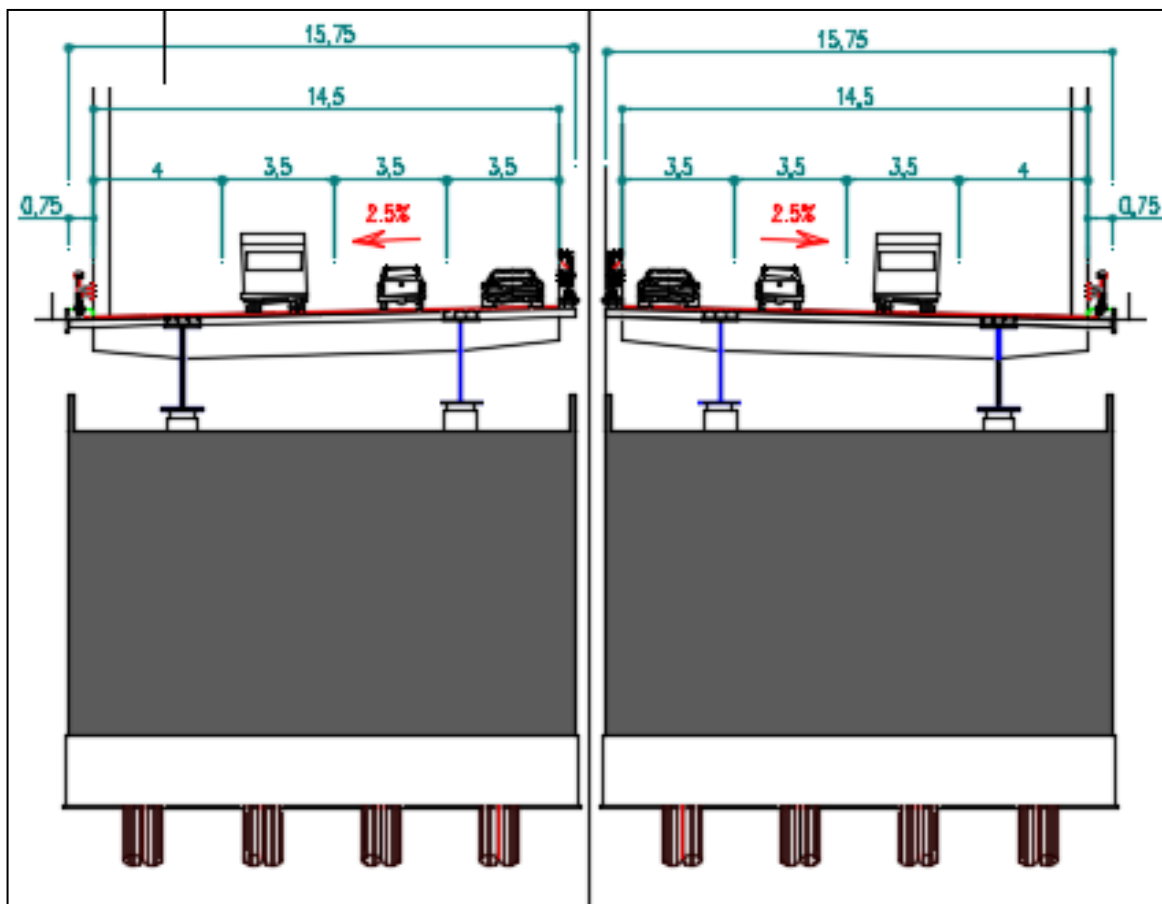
Coupe transversale Sur CULEE VARIANTE 03
